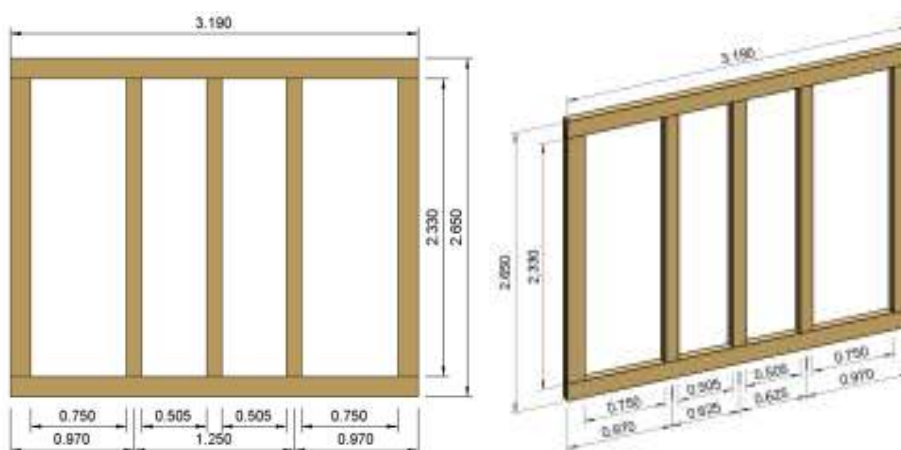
Elemento de parede 3 e 4, constituída por vigas lameladas coladas.
